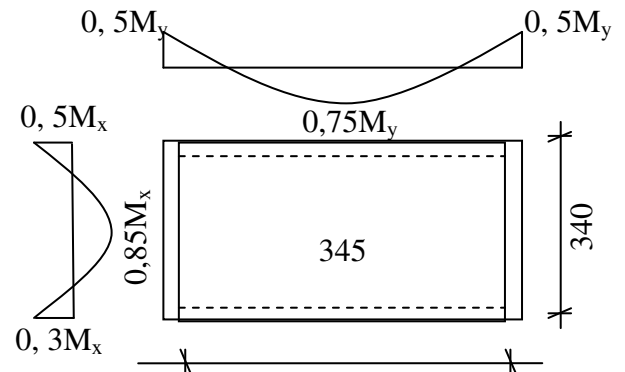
Panneau de dalle appuie sur 4 coté.
